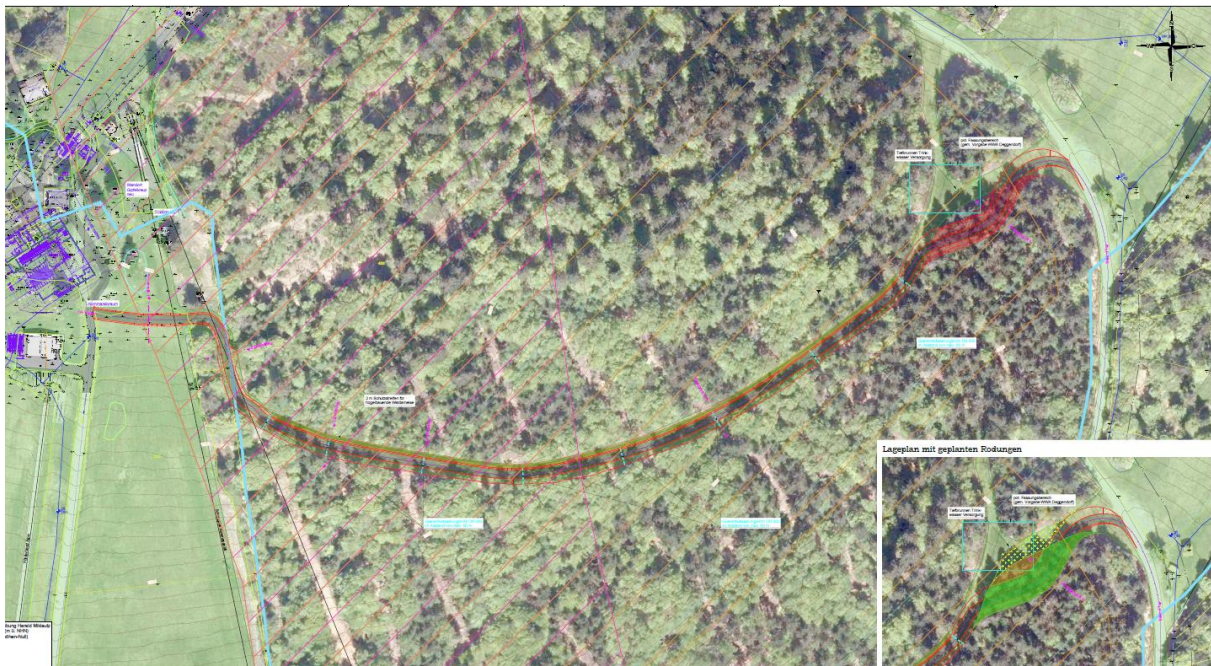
Lageplan mit Darstellung des Projektgebietes und der geplanten Maßnahmen.
